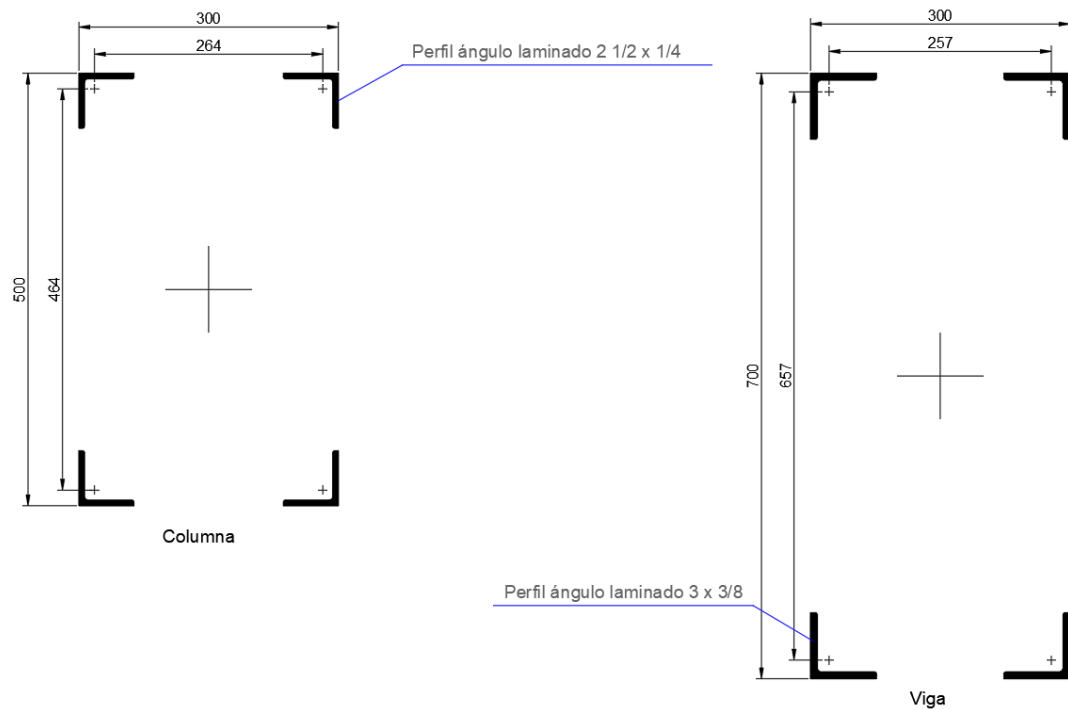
Detalle de la sección de la columna y viga metálica adoptada
